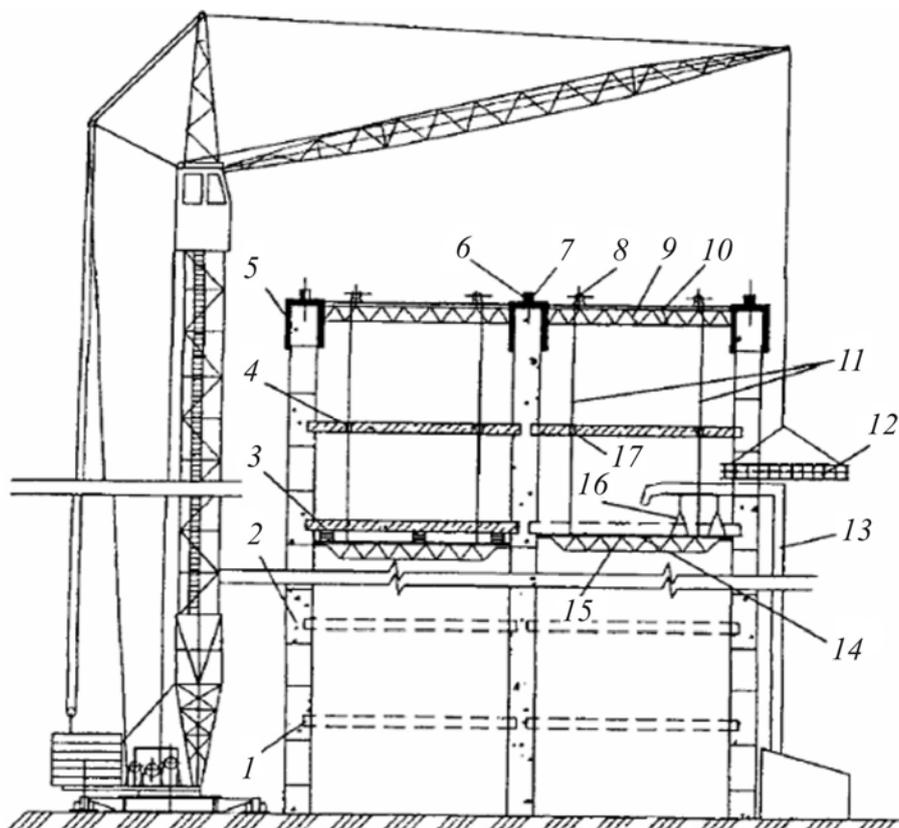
Бетонирование междуэтажных перекрытий методом «сверху вниз»: 1 — гнезда; 2 — стена; 3 — пневматическое отрывное устройство; 4 — монолитное перекрытие; 5 — домкратная рама; 6 — домкратный стержень; 7 — гидродомкрат; 8 — тормозные устройства; 9 — опалубочный щит; 10 — рабочий настил; 11 — гибкие тяги; 12 — армокаркас; 13 — бетоновод; 14 — опалубка перекрытия; 15 — несущая ферма опалубки перекрытия; 16 — стойка; 17 — гильза [23]
